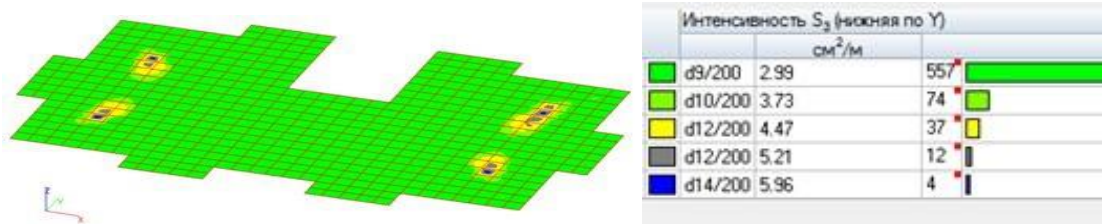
Армирование нижней сетки по оси Y плиты типового этажа
